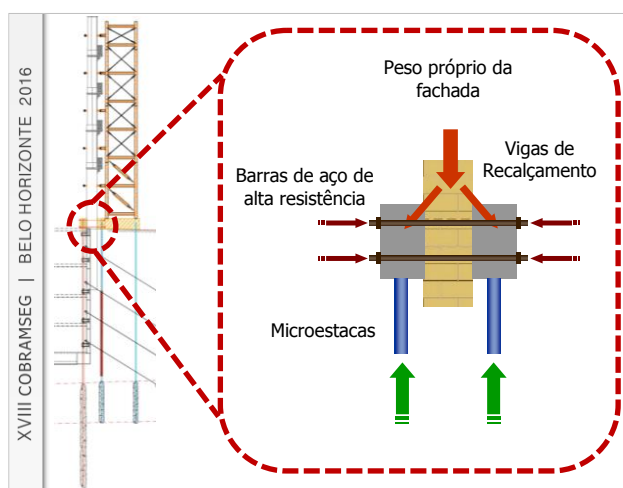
Corte transversal tipo da solução de recalçamento das fachadas.
